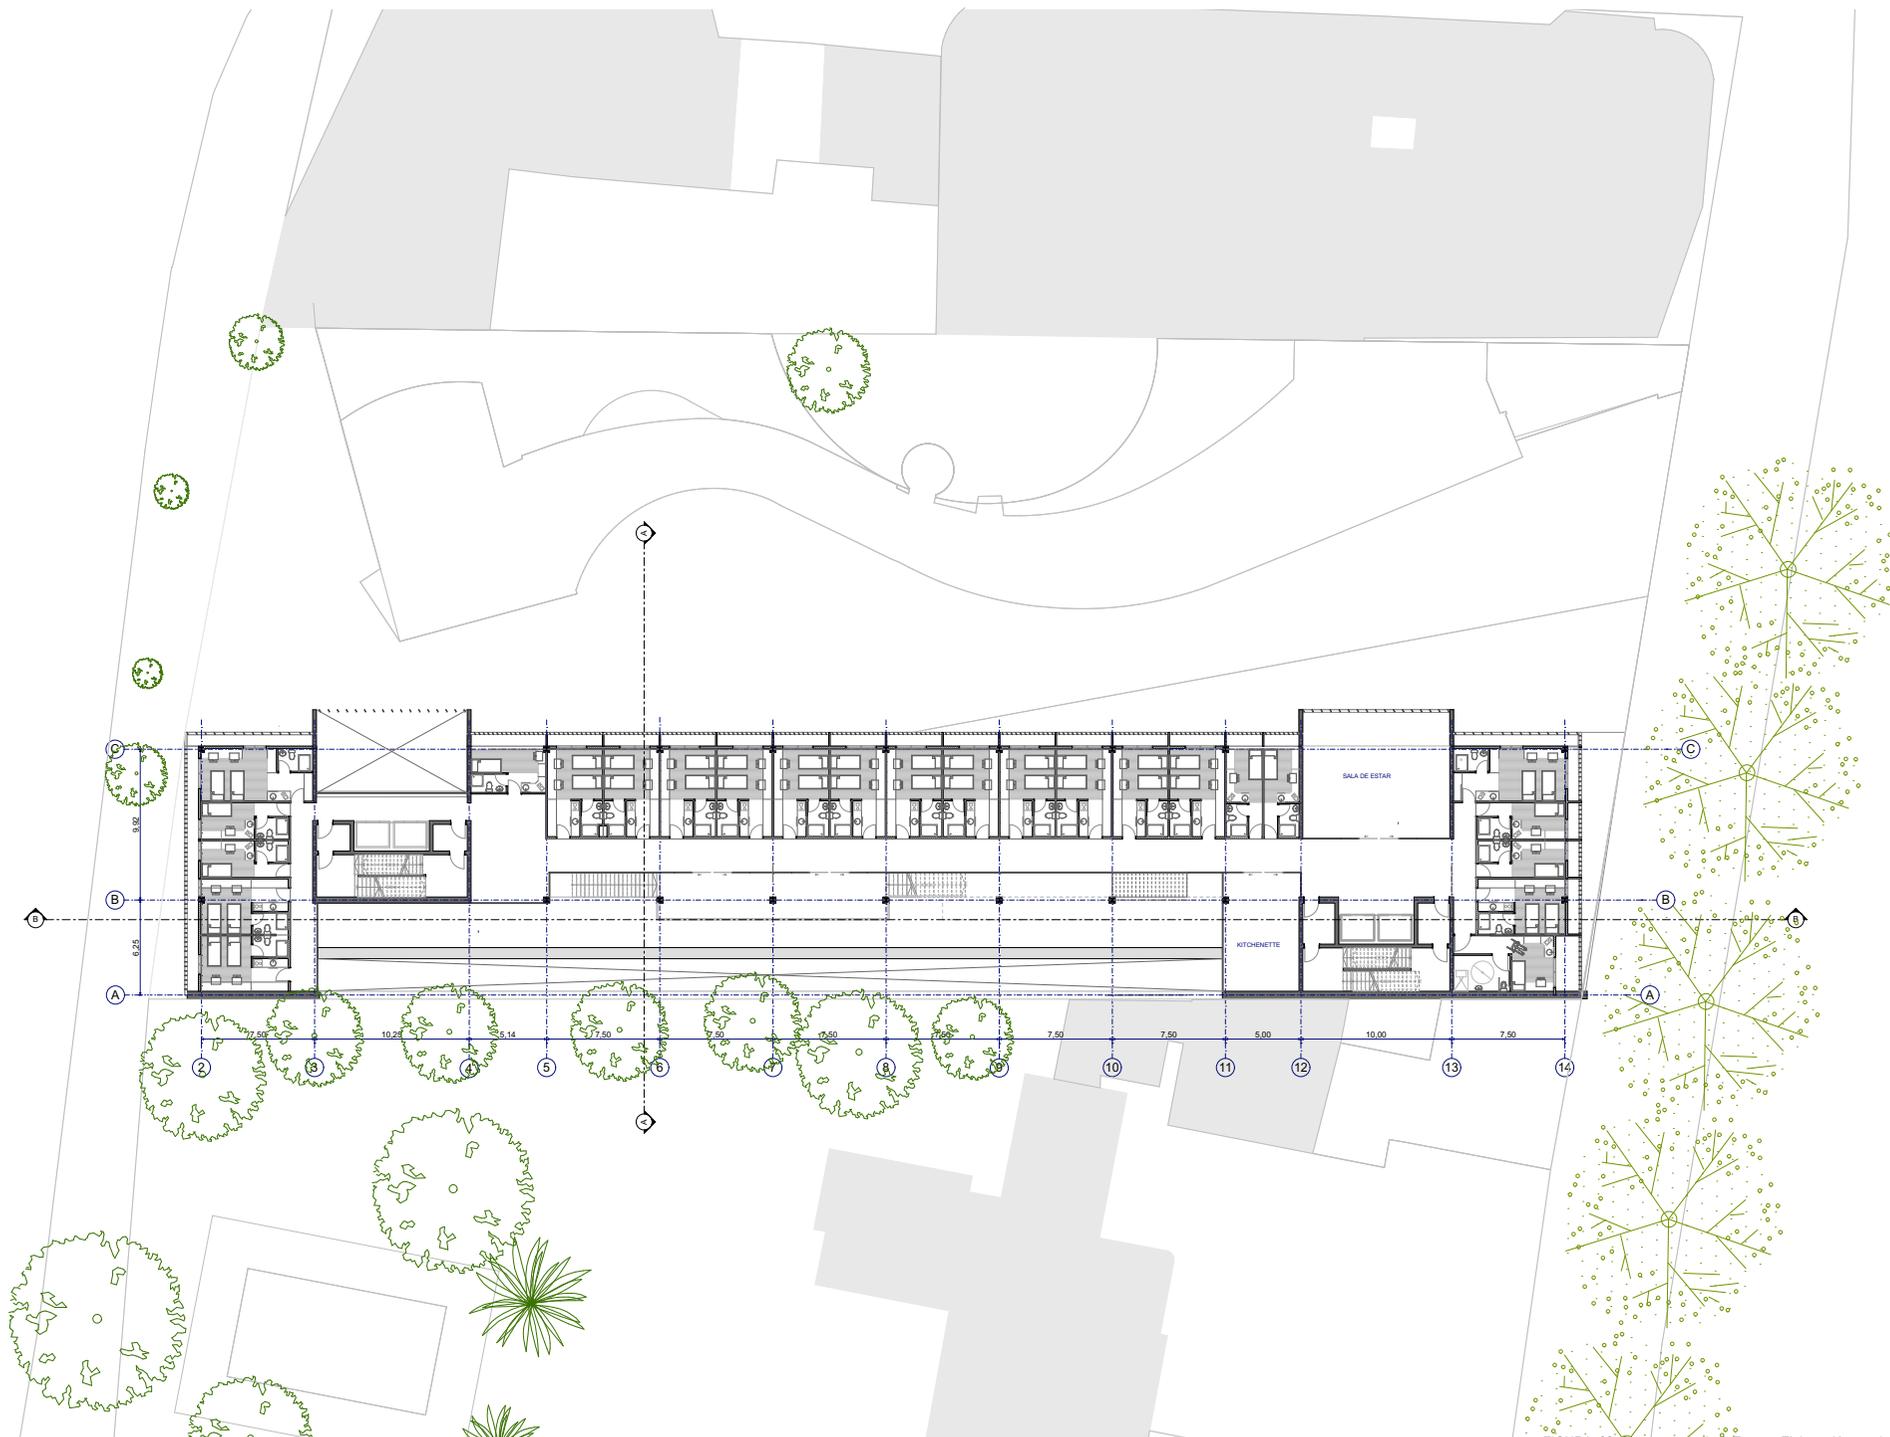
Planta tercer nivel. Fuente: Elaboración propia
